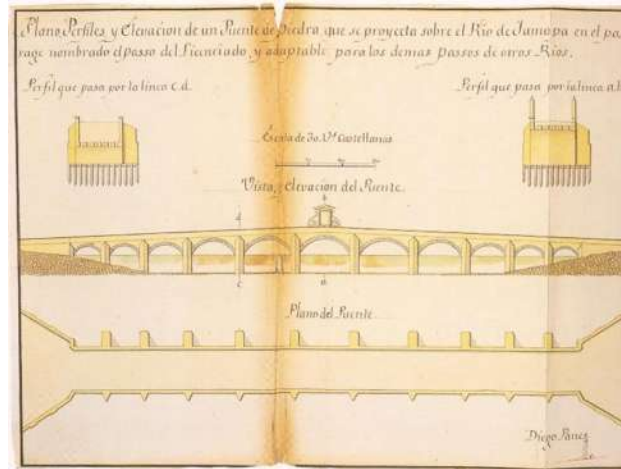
Diseño en planta y alzado de un puente virreinal de piedra sobre el río de Jamapa.
